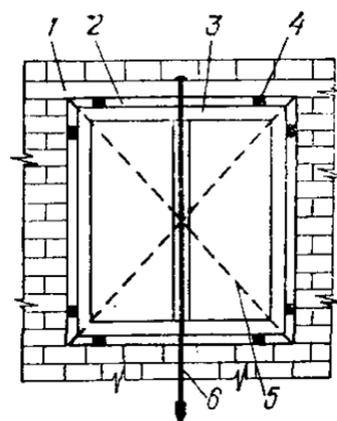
Установка оконной коробки в проем: 1 — стена; 2 — зазор для конопатки; 3 — оконная коробка; 4 — клинья; 5 — проверка по диагонали; 6 — отвес
